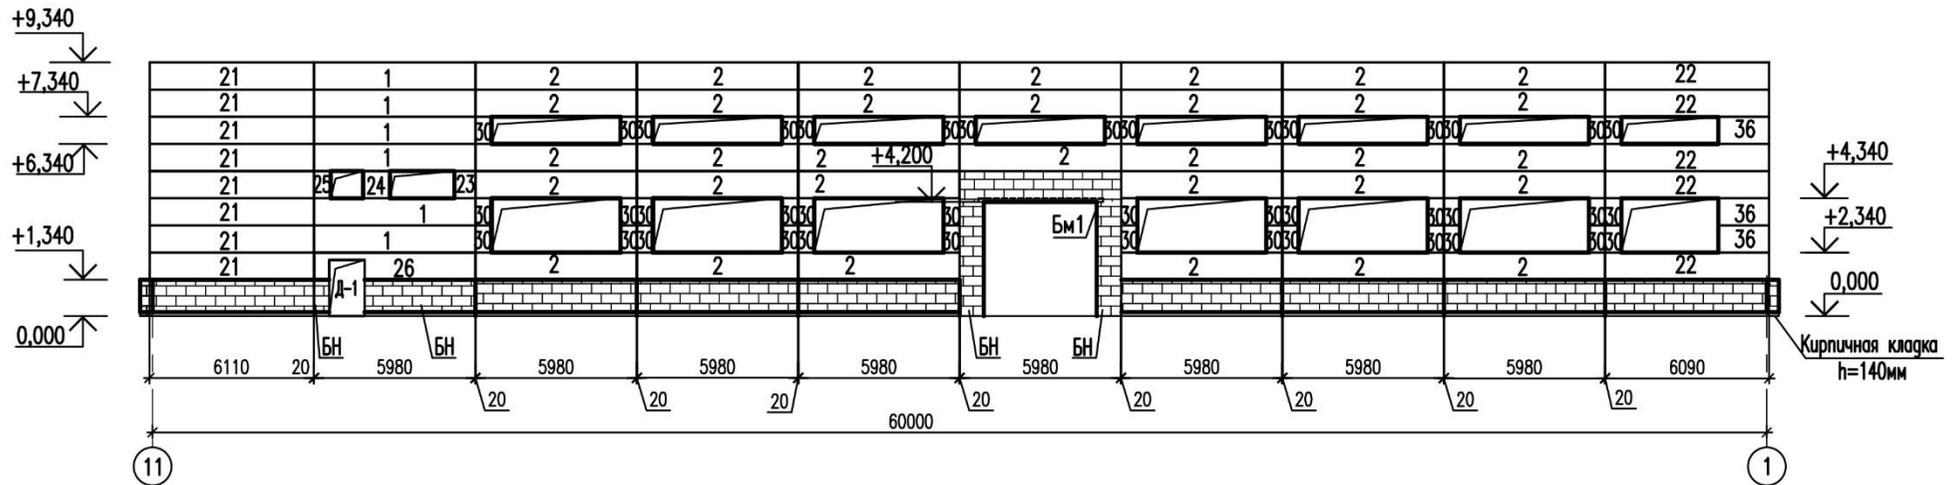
«Схема раскладки сэндвич-панелей на фасаде 11-1» [40]
